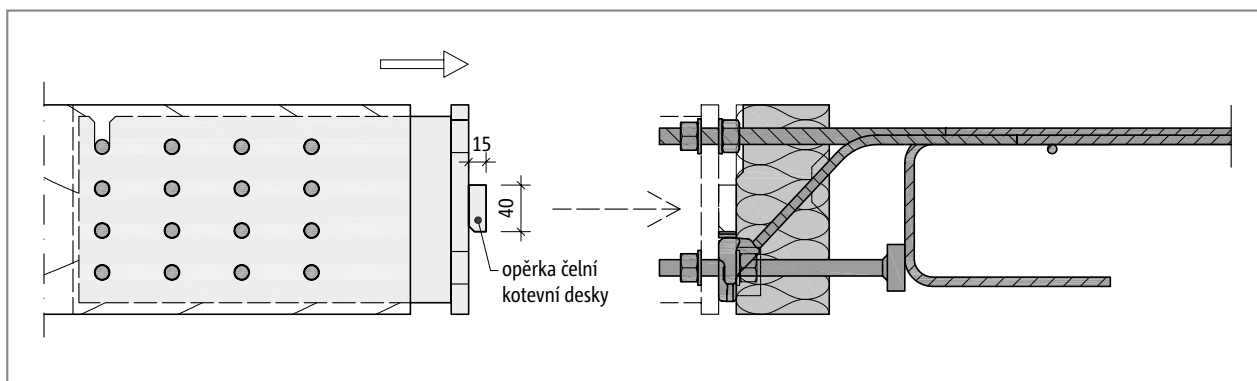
Schöck Isokorb® T typ SKP s přípojným adaptérem: Přípojný adaptér s namontovaným dřevěným trámem
